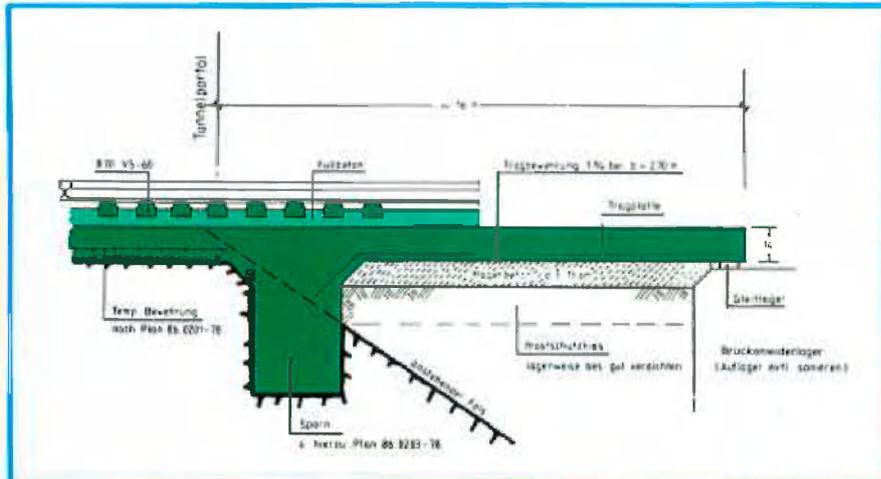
Übergangskonstruktion Tunnel – Brücke
